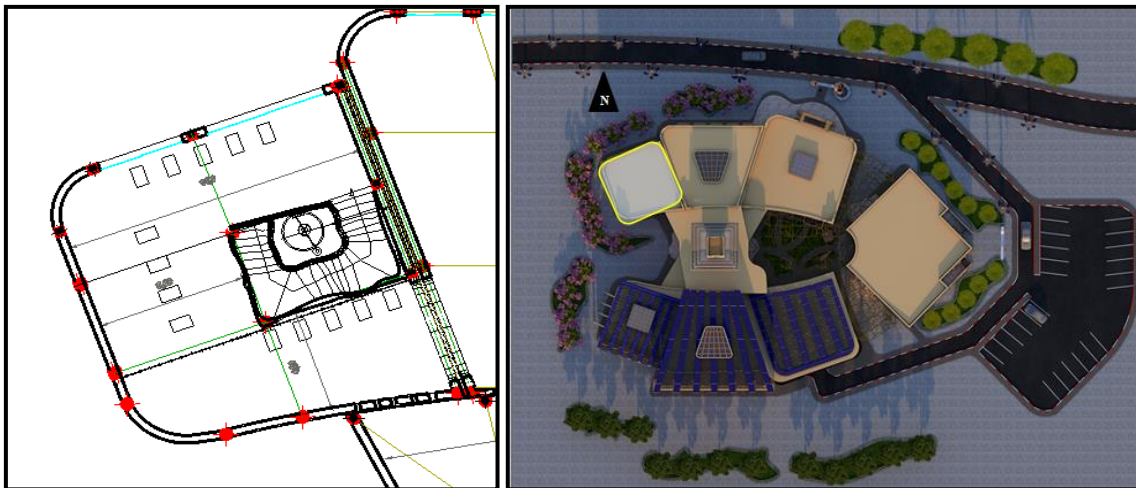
vue sur le plan de zone d'étude source : Auteurs
